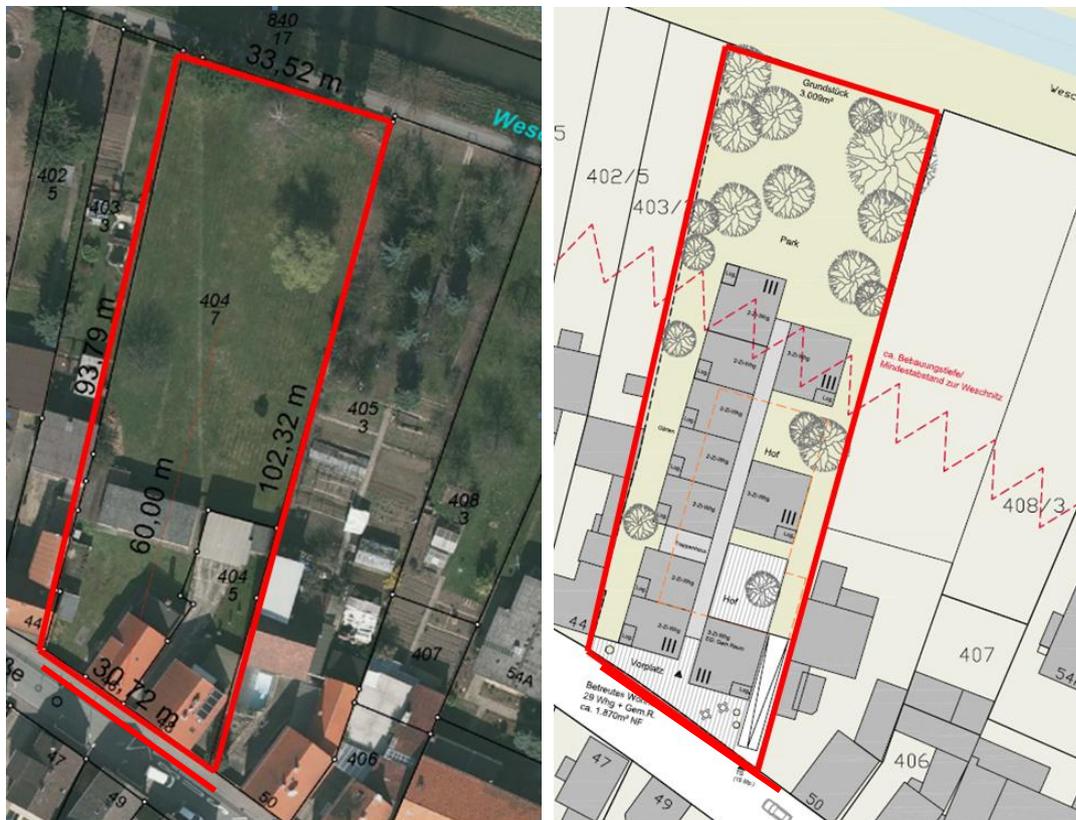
und 2: Luftbild der Grundstücke im gegenwärtigen Zustand (links, Quelle: Gem. Einhausen). Planung der Wohnbebauung (rechts, Quelle: Bilger Fellmeth Architekten)
